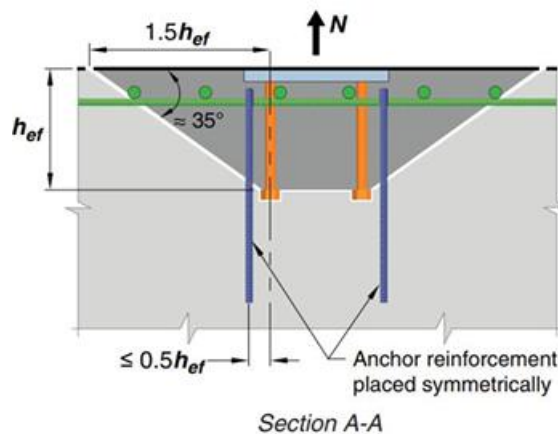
Armadura de acero para tracción. (AISC Design Guide 01)
